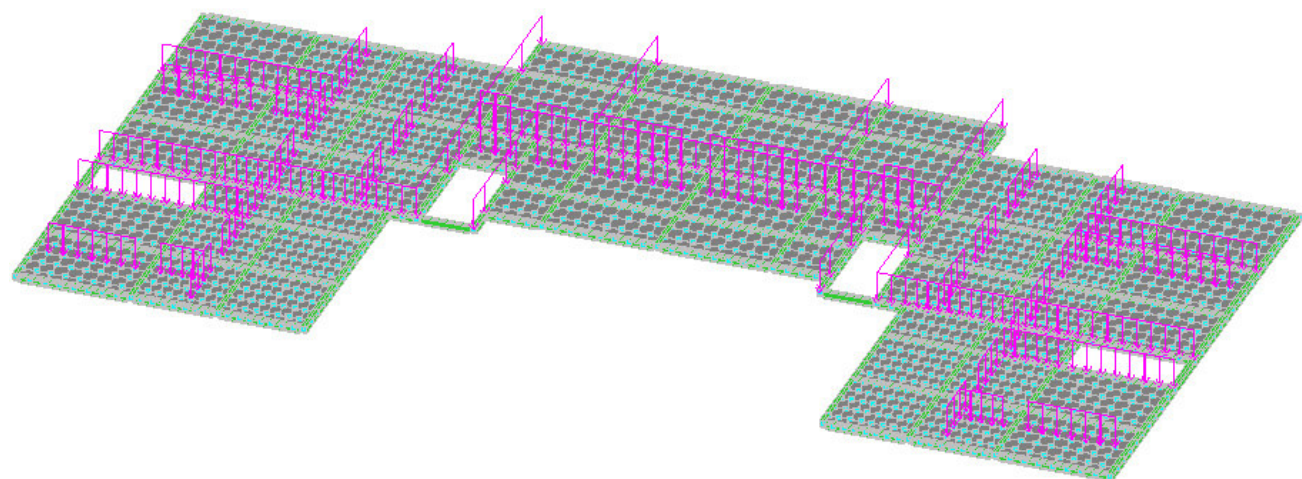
Задание нагрузок от веса перегородок на стержни малой жесткости
